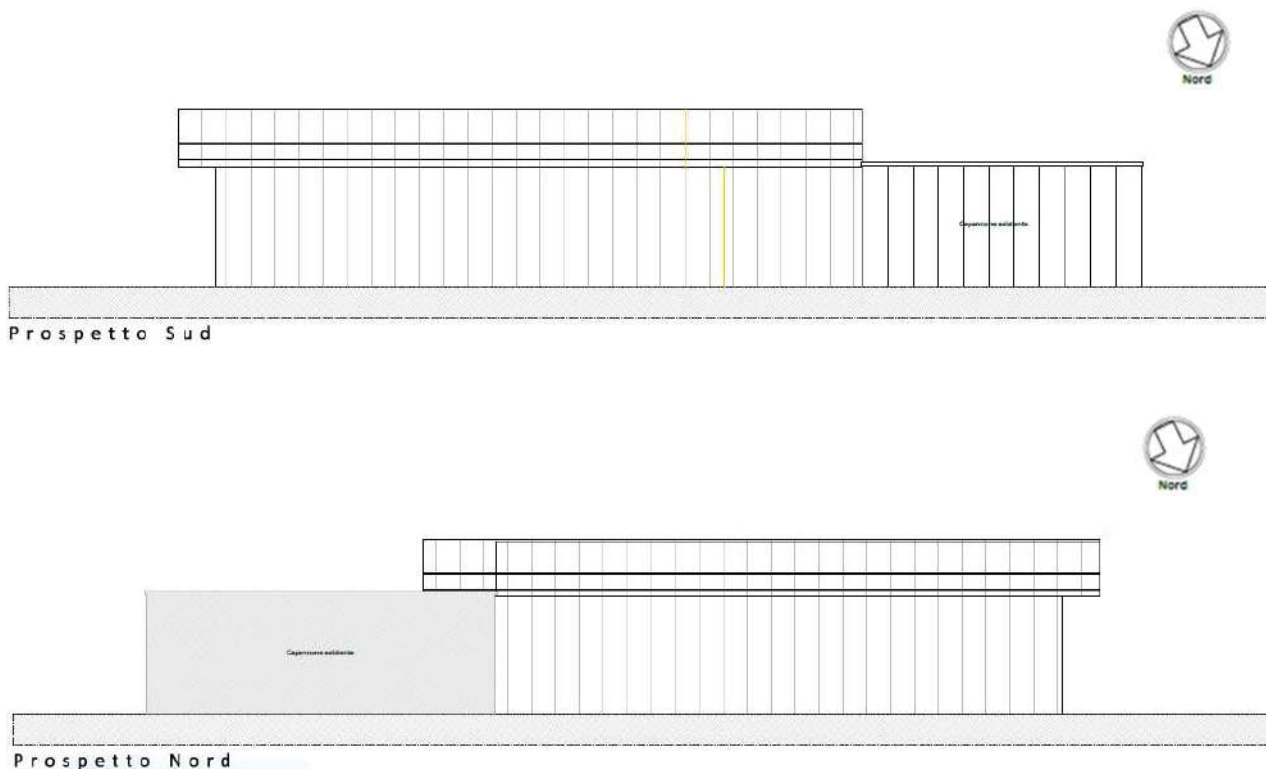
e 13b: Prospetti Sud e Nord dell'ampliamento in progetto
